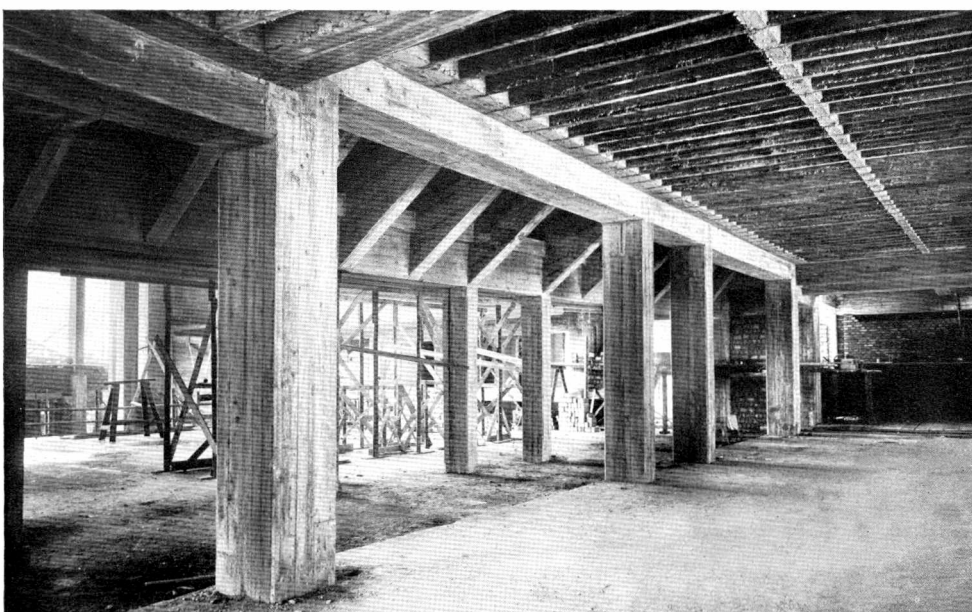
Ufapalast Stuttgart, Untersicht unter Balkon und Amphitheater (Ludwig Bauer, Stuttgart) Phot. Dr. Lossen
